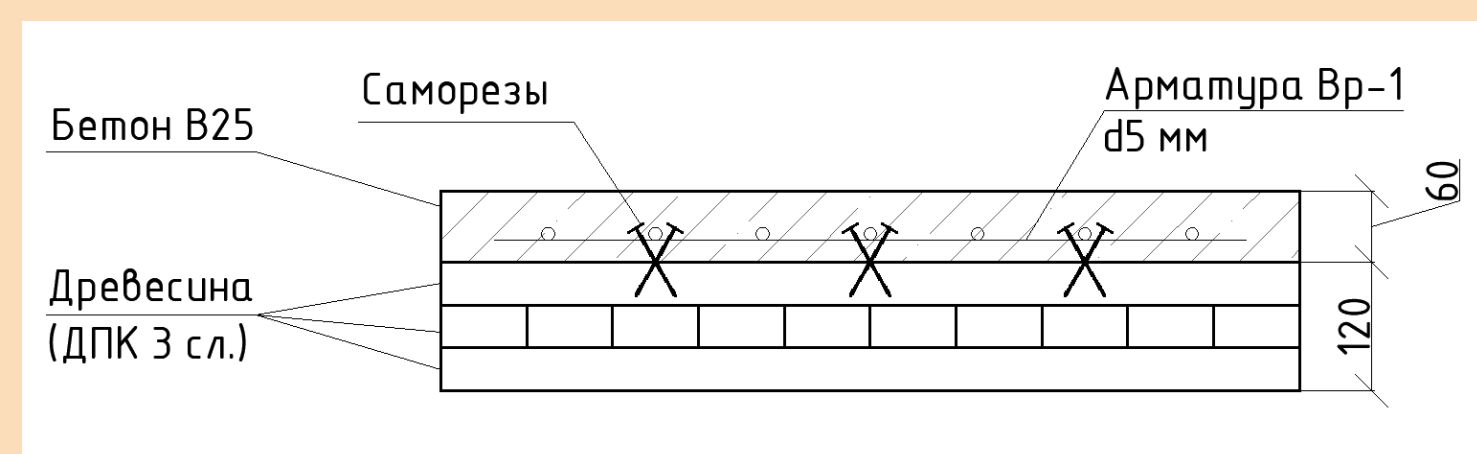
Эскиз конструкции составной деревобетонной плиты перекрытия
